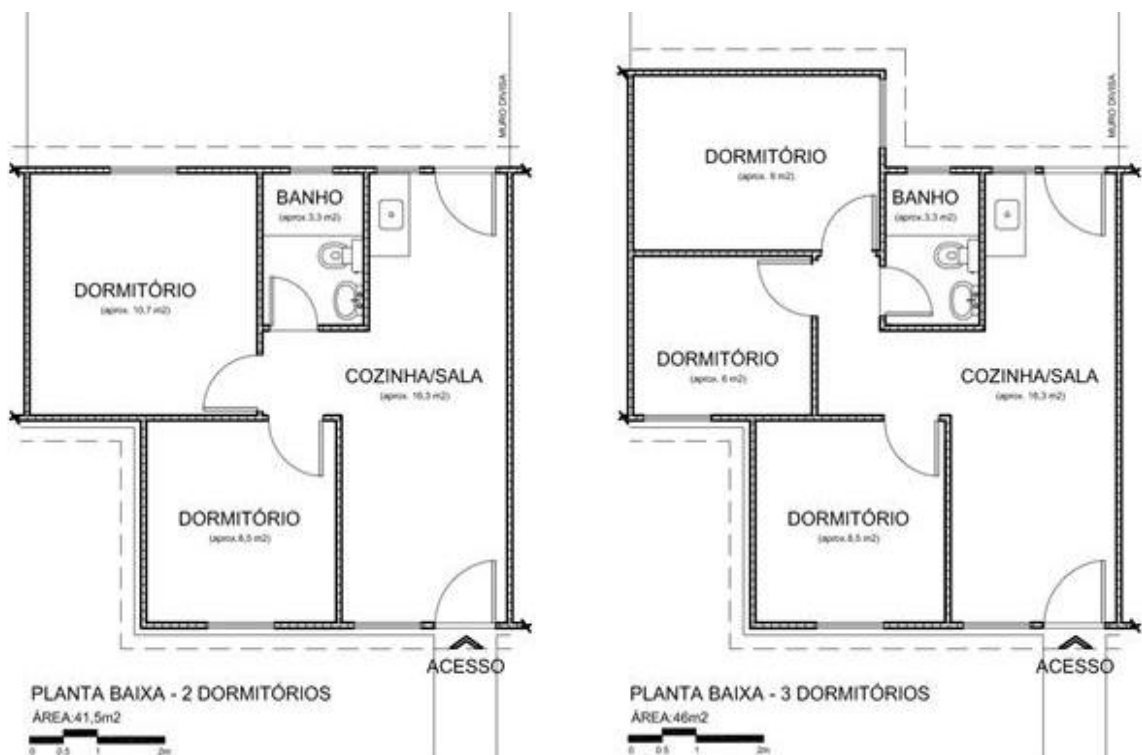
Planta baixa esquemática: Condomínio São Luiz.
